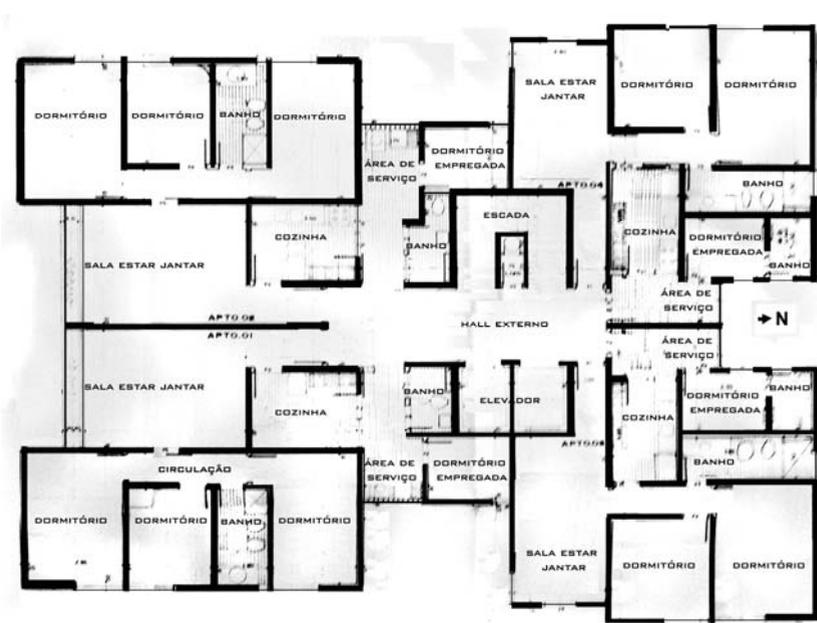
Planta baixa do pavimento tipo – edifício Gemini II
